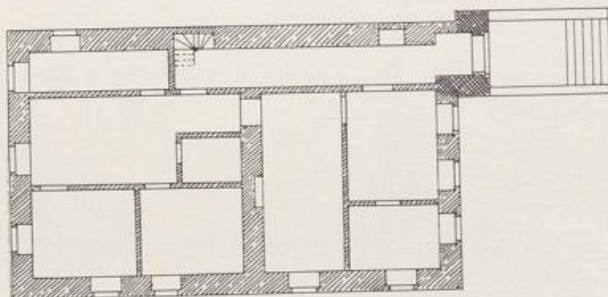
Juntersdorf. Grundriss des Herrenhauses der Burg.
